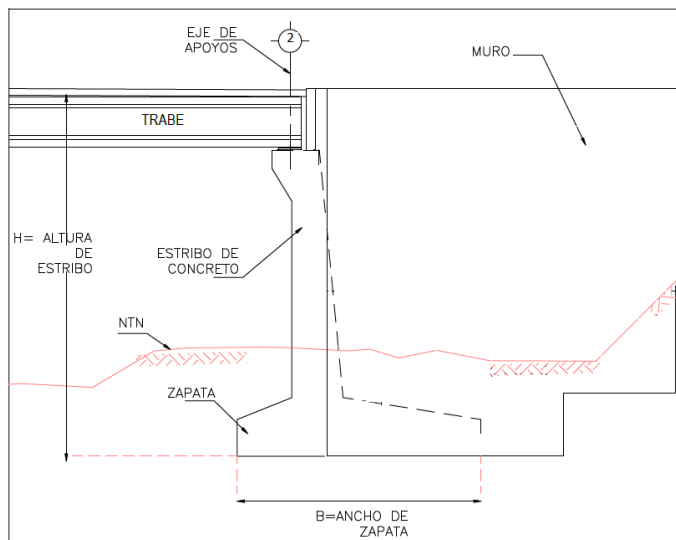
Estructura para estribo de Puente, conformada por aleros, zapata superficial y muro frontal, tomado de la Guía de exploración y elaboración de estudios y proyectos para la cimentación de puentes, SCT 2014
